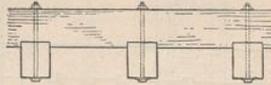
Balken an einem Ueberzuge aufgehängt mittels Schrauben.
